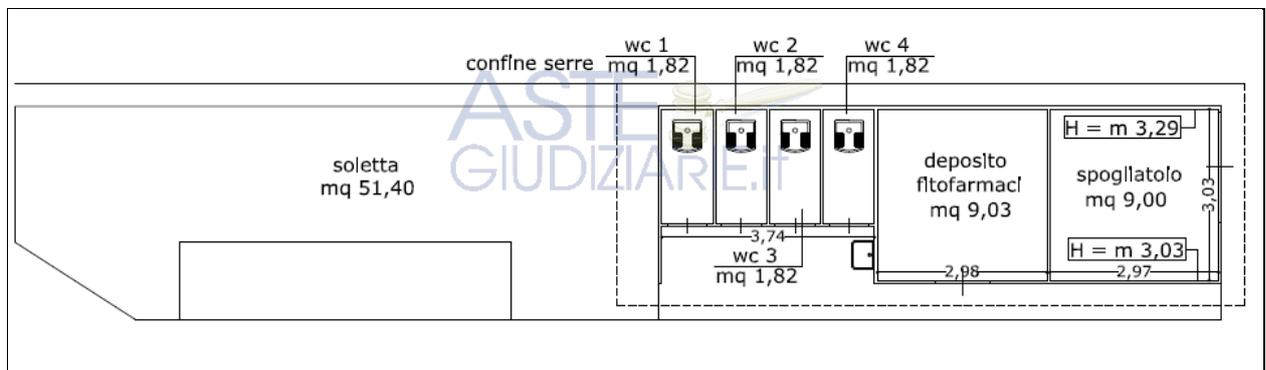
LOTTO 5- manufatti tecnici su p. ILLA 1803
